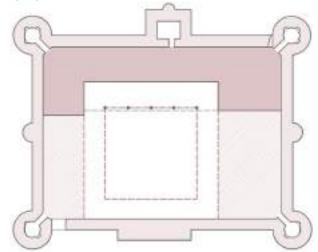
Esquema en planta baja de cómo podría el recinto interior haber albergado la traza completa del palacio. Elaboración propia.
